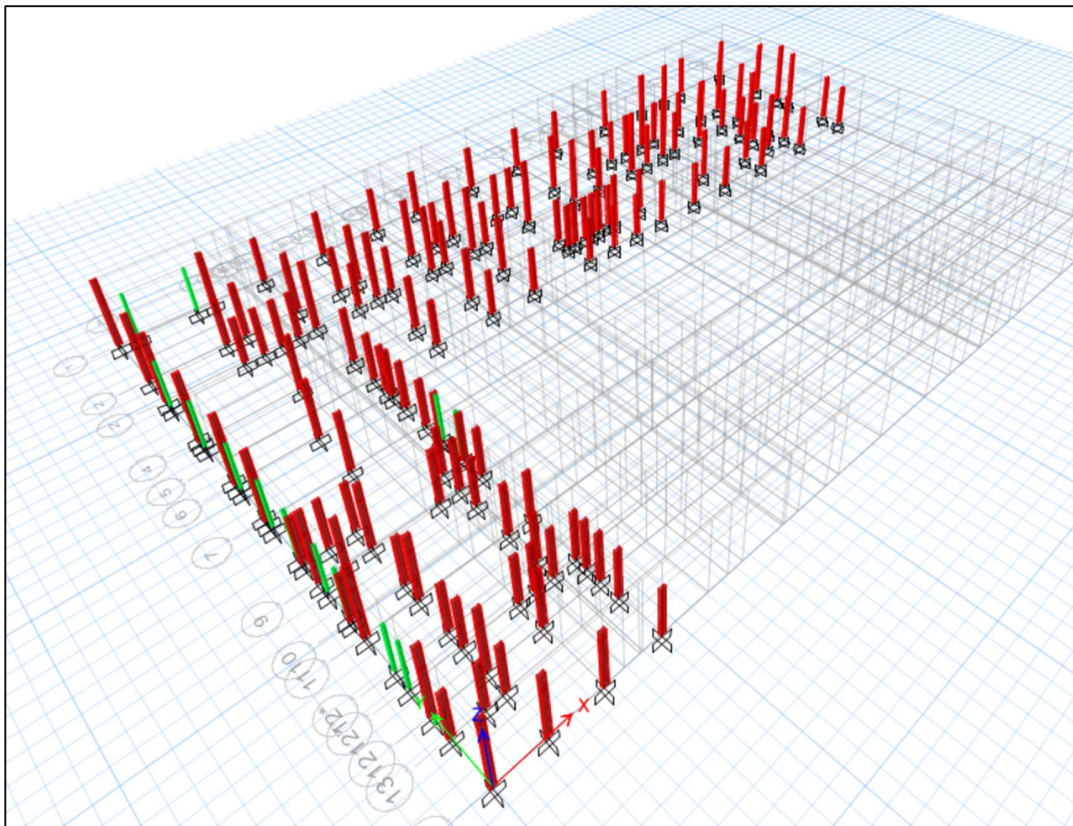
Vista de columnas – ROJAS 15CMX15CM – VERDE (10CMX10CM\_VENTANAS)
